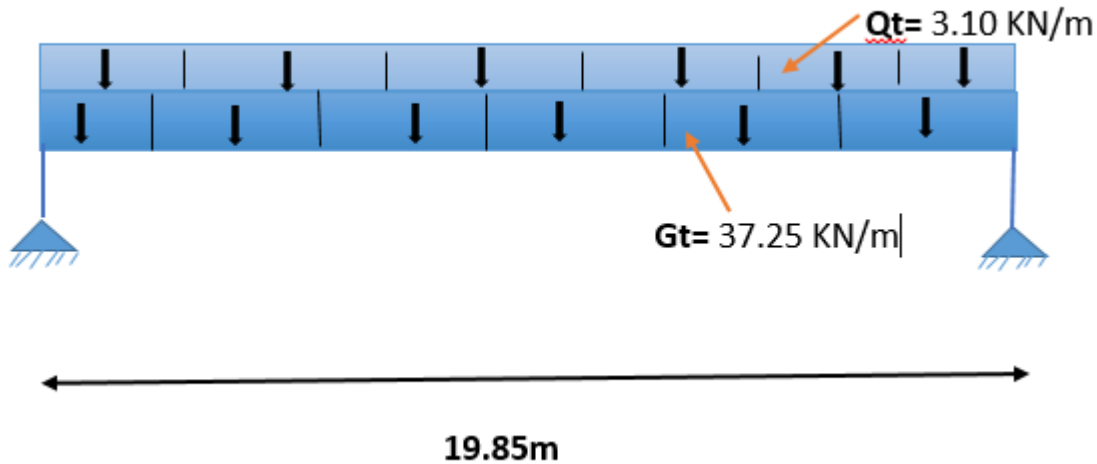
Chargement permanente et exploitation de la poutre principale.
